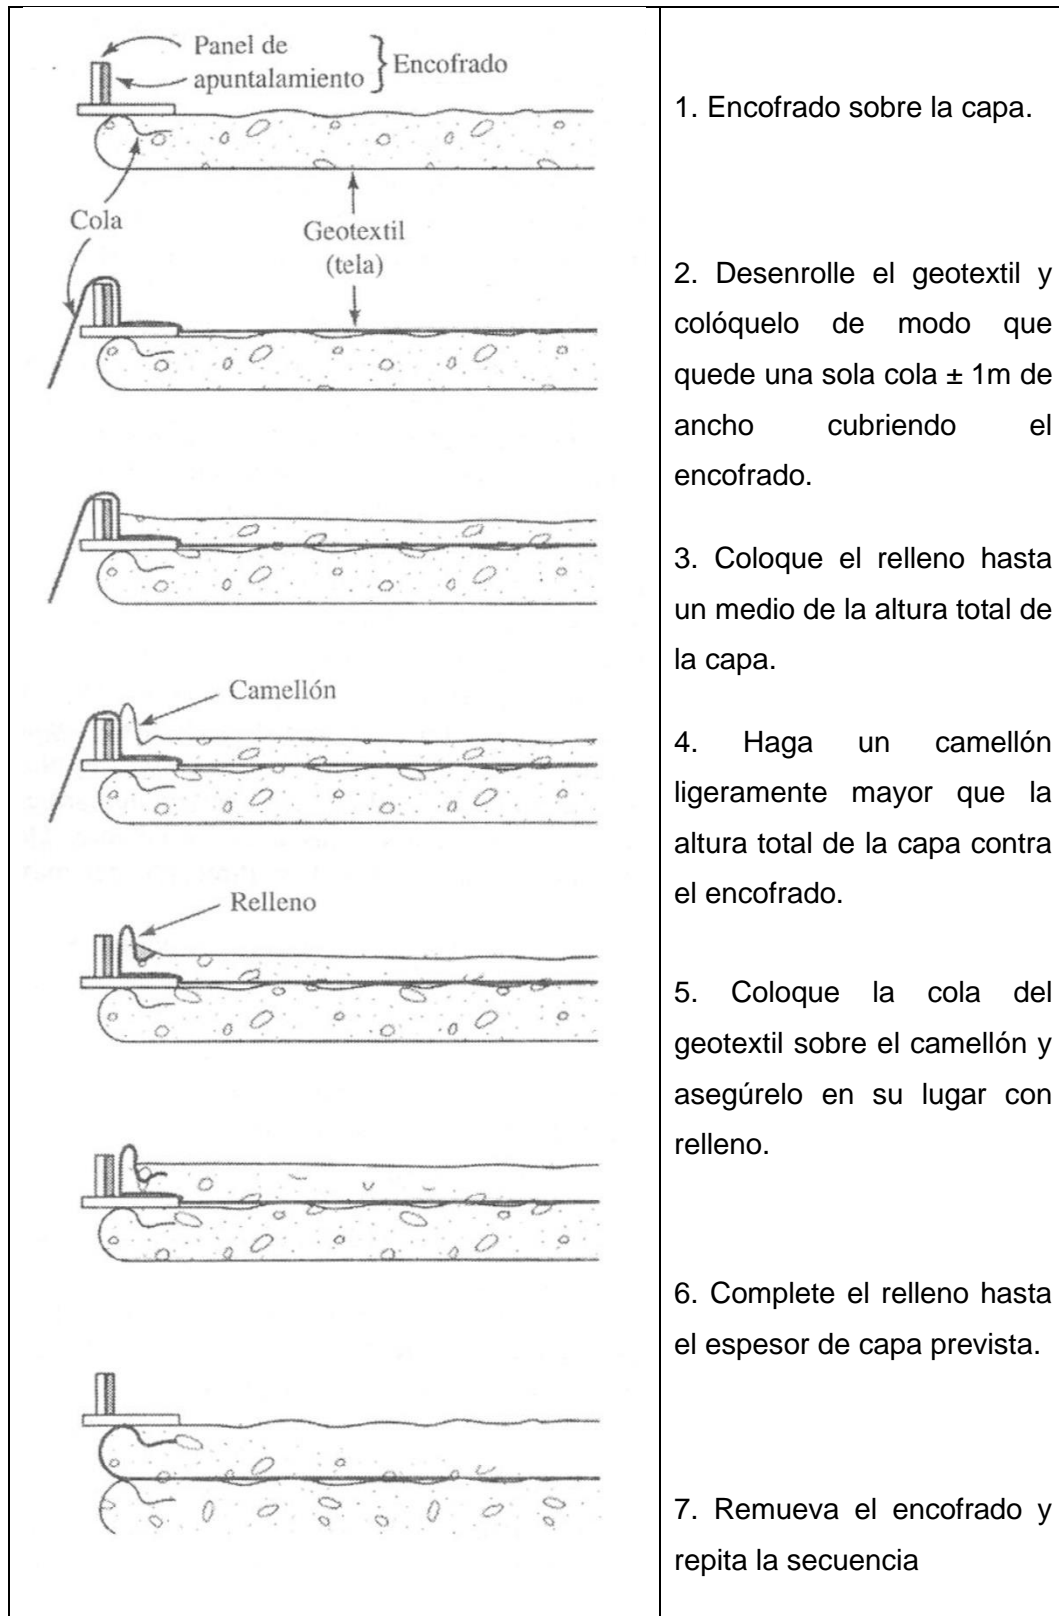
Secuencia constructiva de muro de suelo reforzado con geotextiles sugerida por el Servicio de Bosques de los E.E.U.U.
